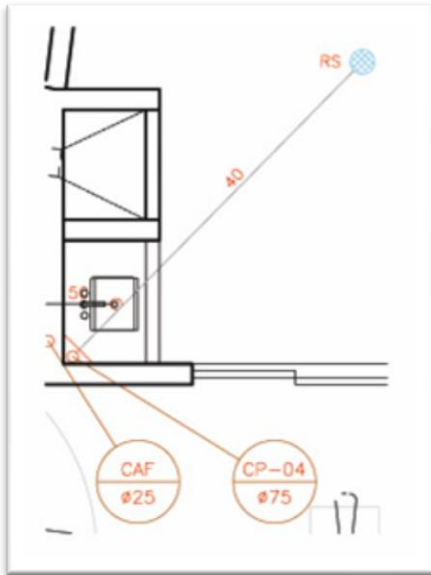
Planta baixa desalinhamento da prumada de esgoto com parede.
